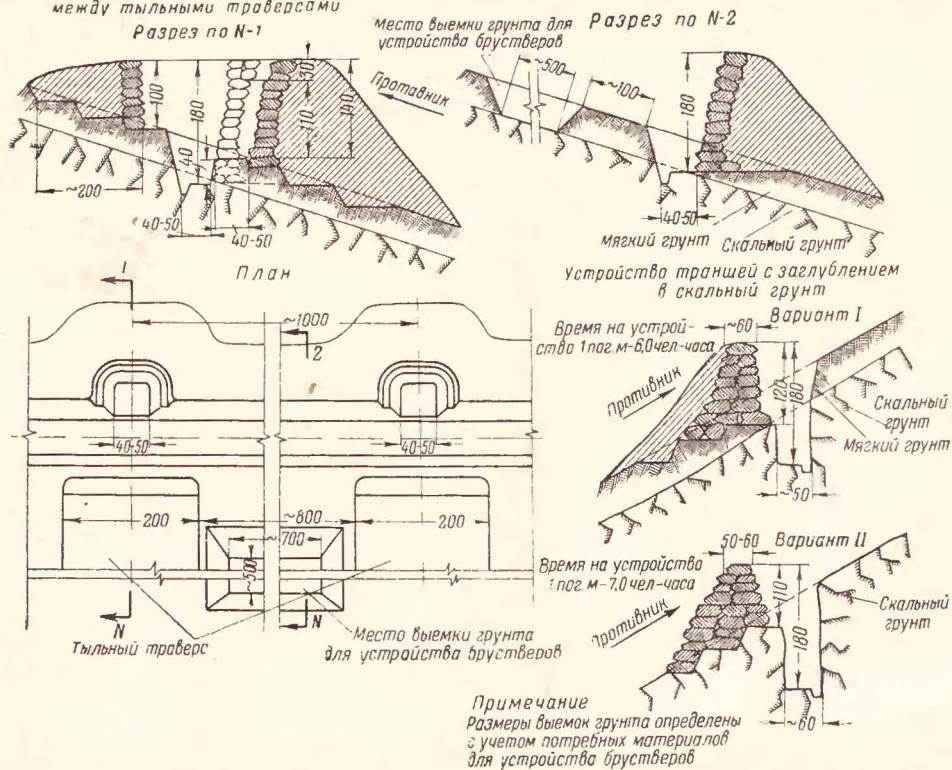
Профили окопов и траншей с брустверами из камня и грунта на переднем скате высоты
